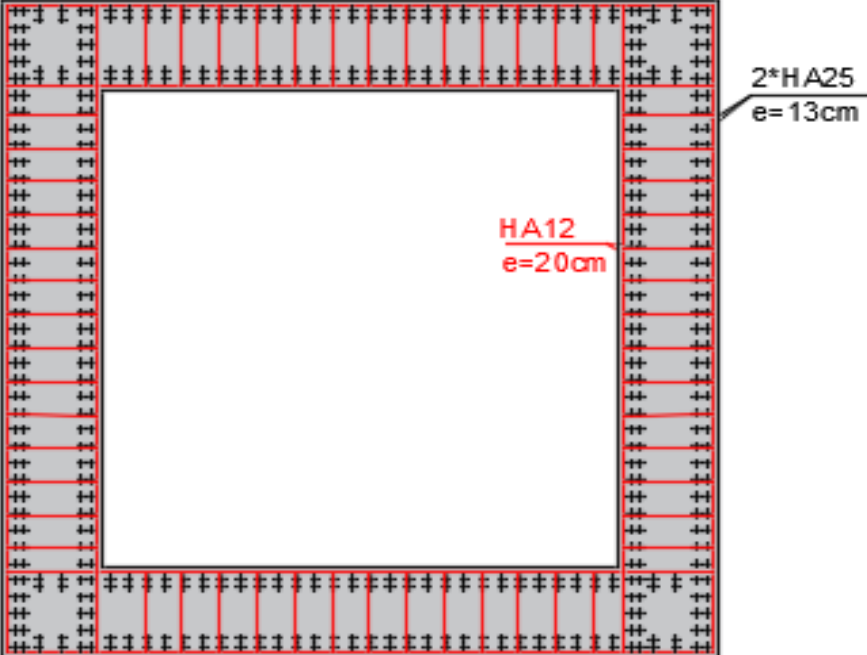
coupe transversal qui montre le ferrailage de la pile 02
